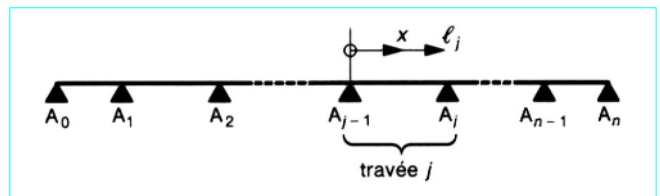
Poutre continue sur  $(n + 1)$  appuis simples
